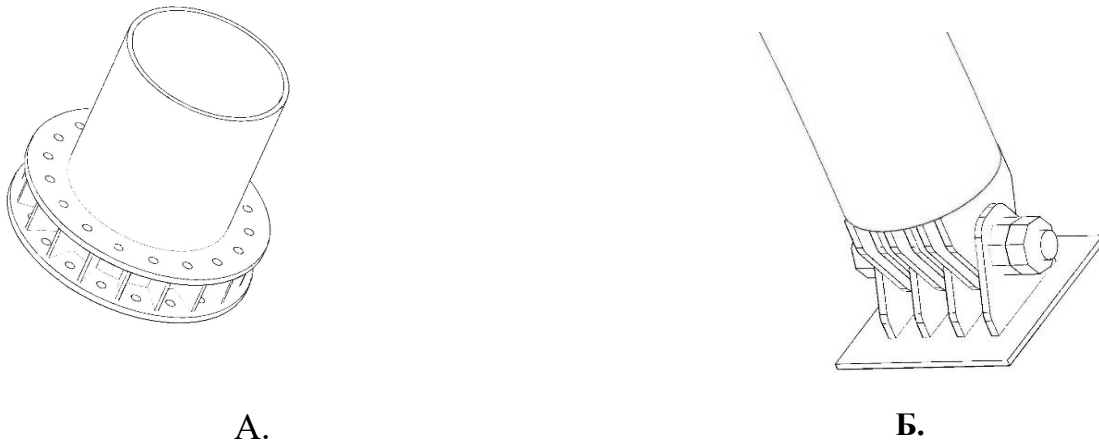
Узлы опирания арок на фундаменты: А- жесткое; Б- шарнирное
